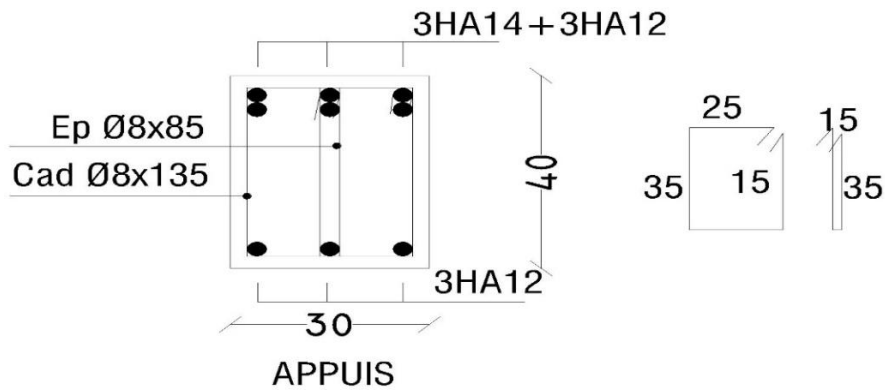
Ferrailage de la poutre principale (RDC et EC), sur appui
